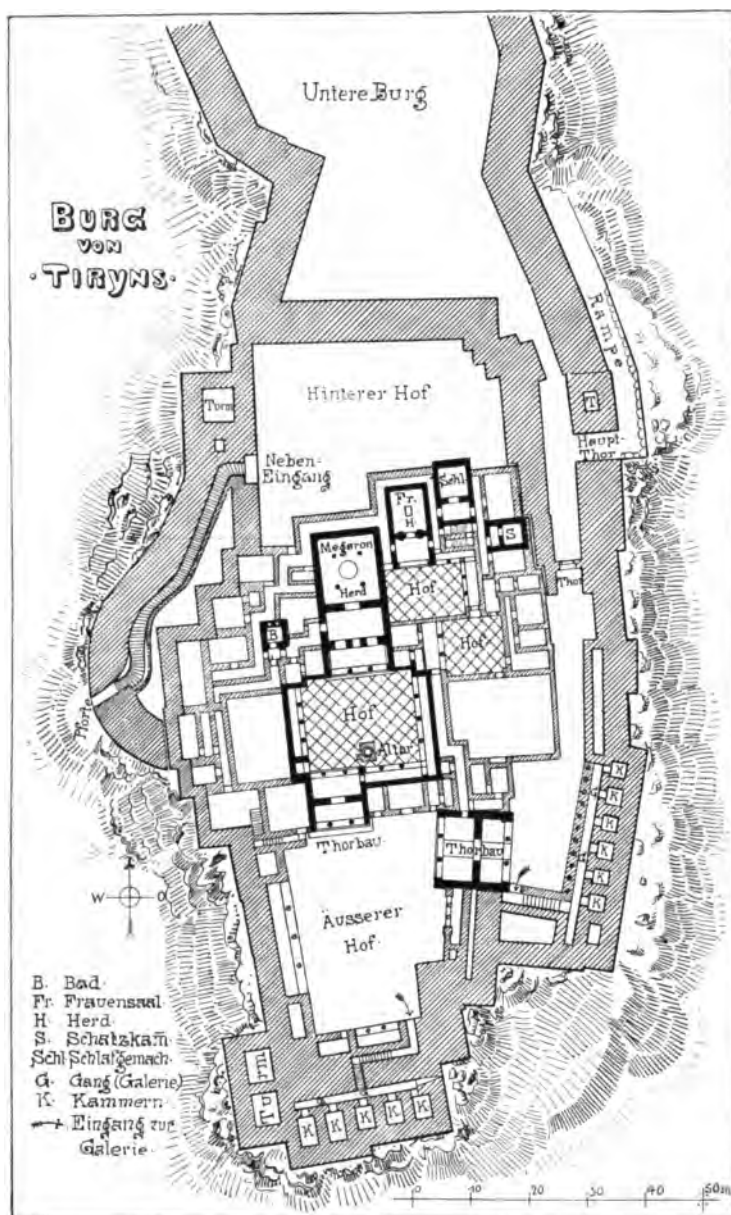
(β). Palast von Tiryns Grundriss.
